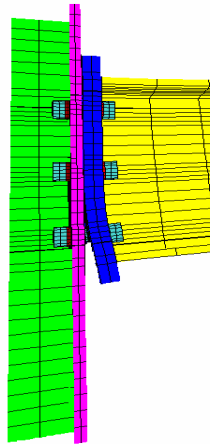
Déformée de l'assemblage avec poteau rigide
